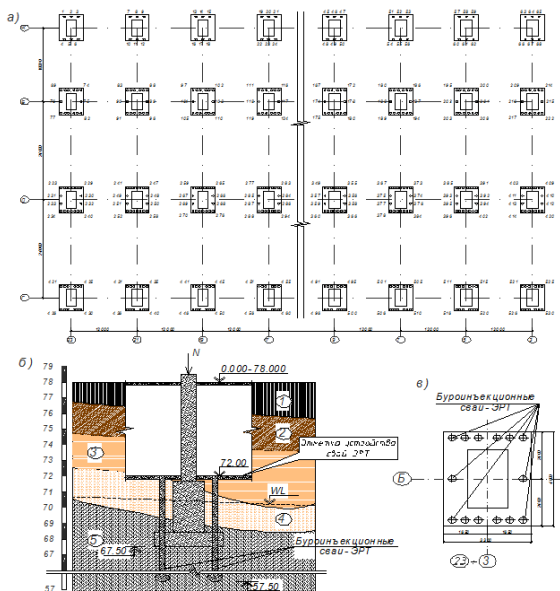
а – план расположения буринъекционных свай ЭРТ; б – сечение фундамента в осях Д/12 с привязкой в инженерно-геологический разрез; в – план буринъекционных свай ЭРТ усиления основания в осях Б/5; 1 – насыпной грунт; 2 – суглинок полутвердый; 3 – супесь; 4 – глина твердая; 5 – пески мелкие водонасыщенные
